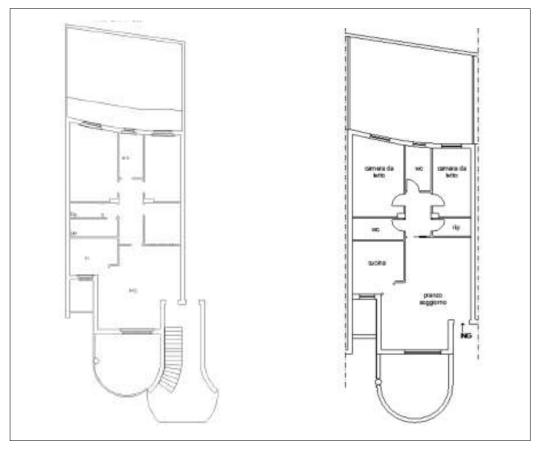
Planimetria catastale dell'appartamento sub 44 e rilievo stato di fatto
